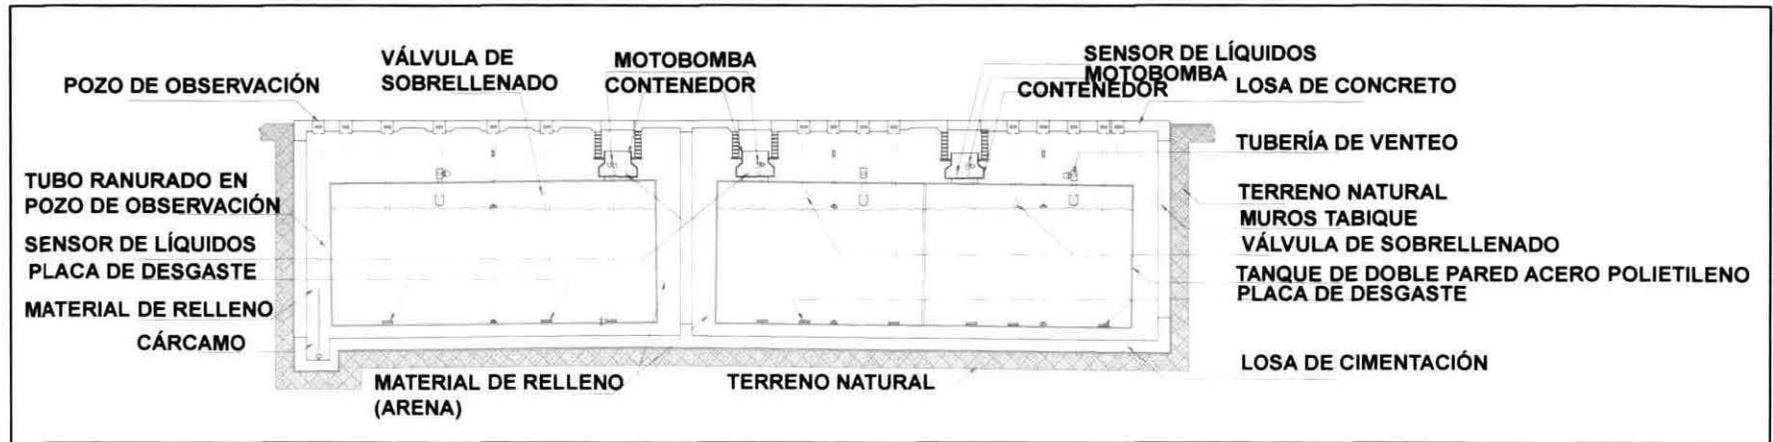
Detalle fosa de tanques, sección longitudinal.
